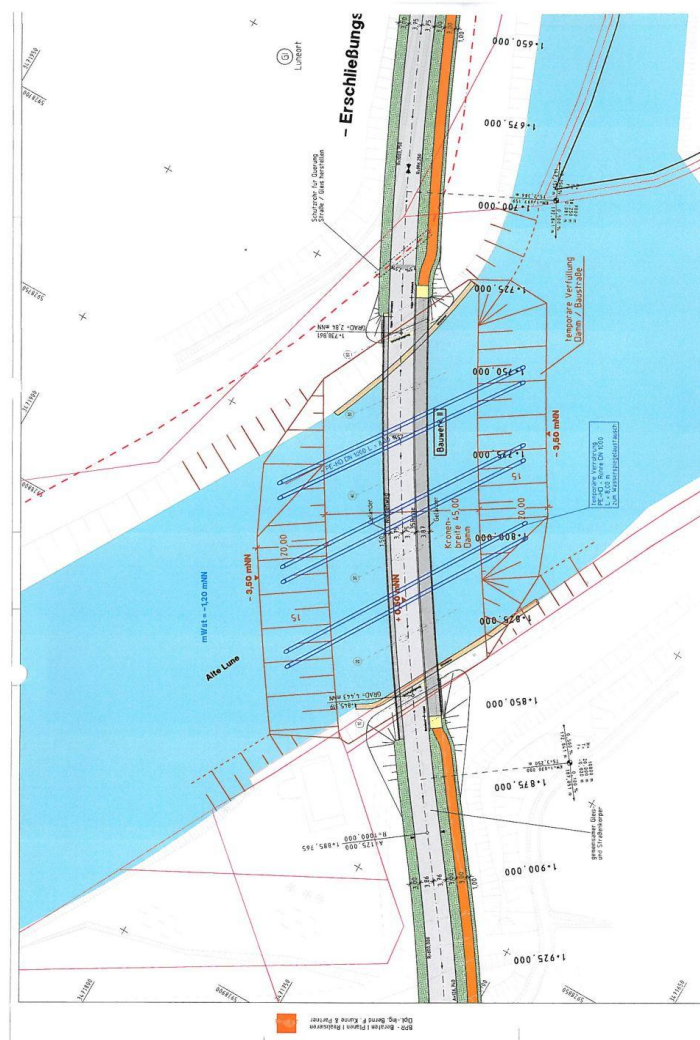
Lageplan zum Brückenbauwerk II im B-Plan 429.
